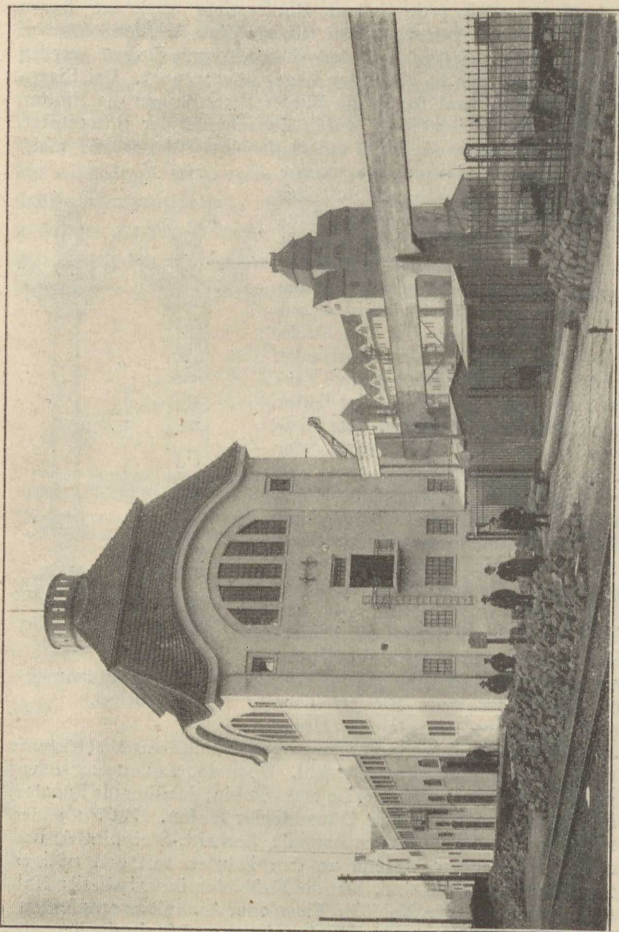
Lagerhaus Düsseldorf mit Kranträgern aus Eisenbeton.
